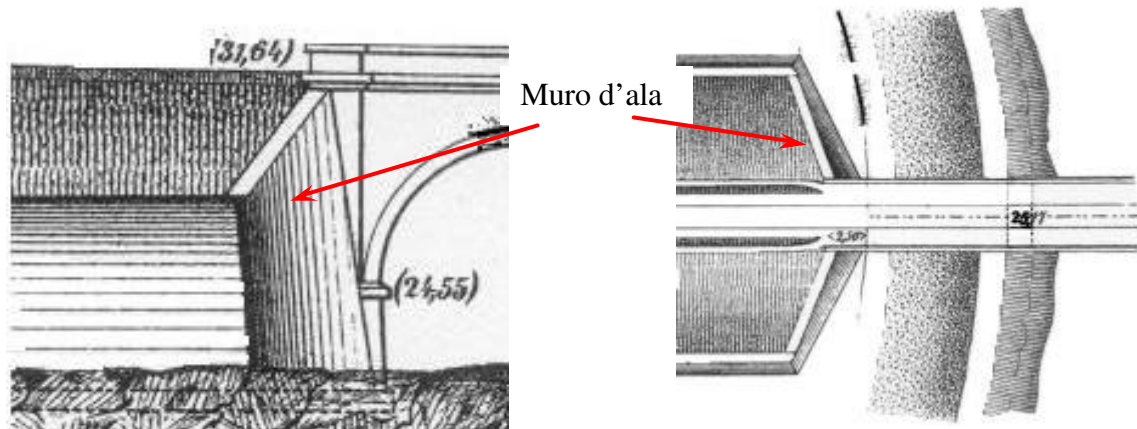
Prospetto e planimetria di muro d'ala (Curioni, 1871).
